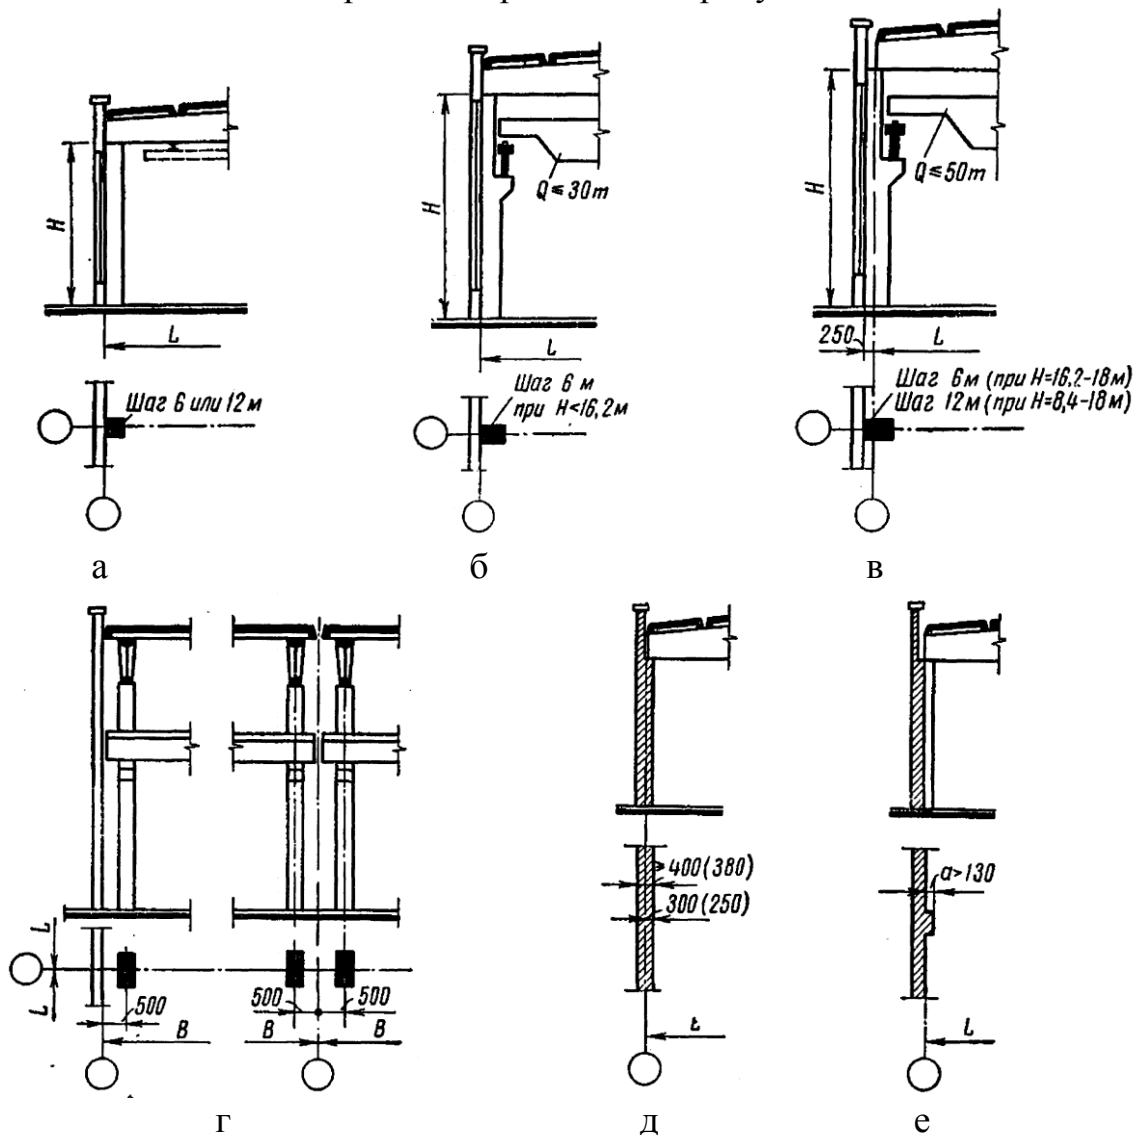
Привязка колонн и стен: а, б, в – к продольным разбивочным осям; г – к поперечным разбивочным осям; д – привязка несущих стен без пилястр; е – то же, стен с пилястрами
